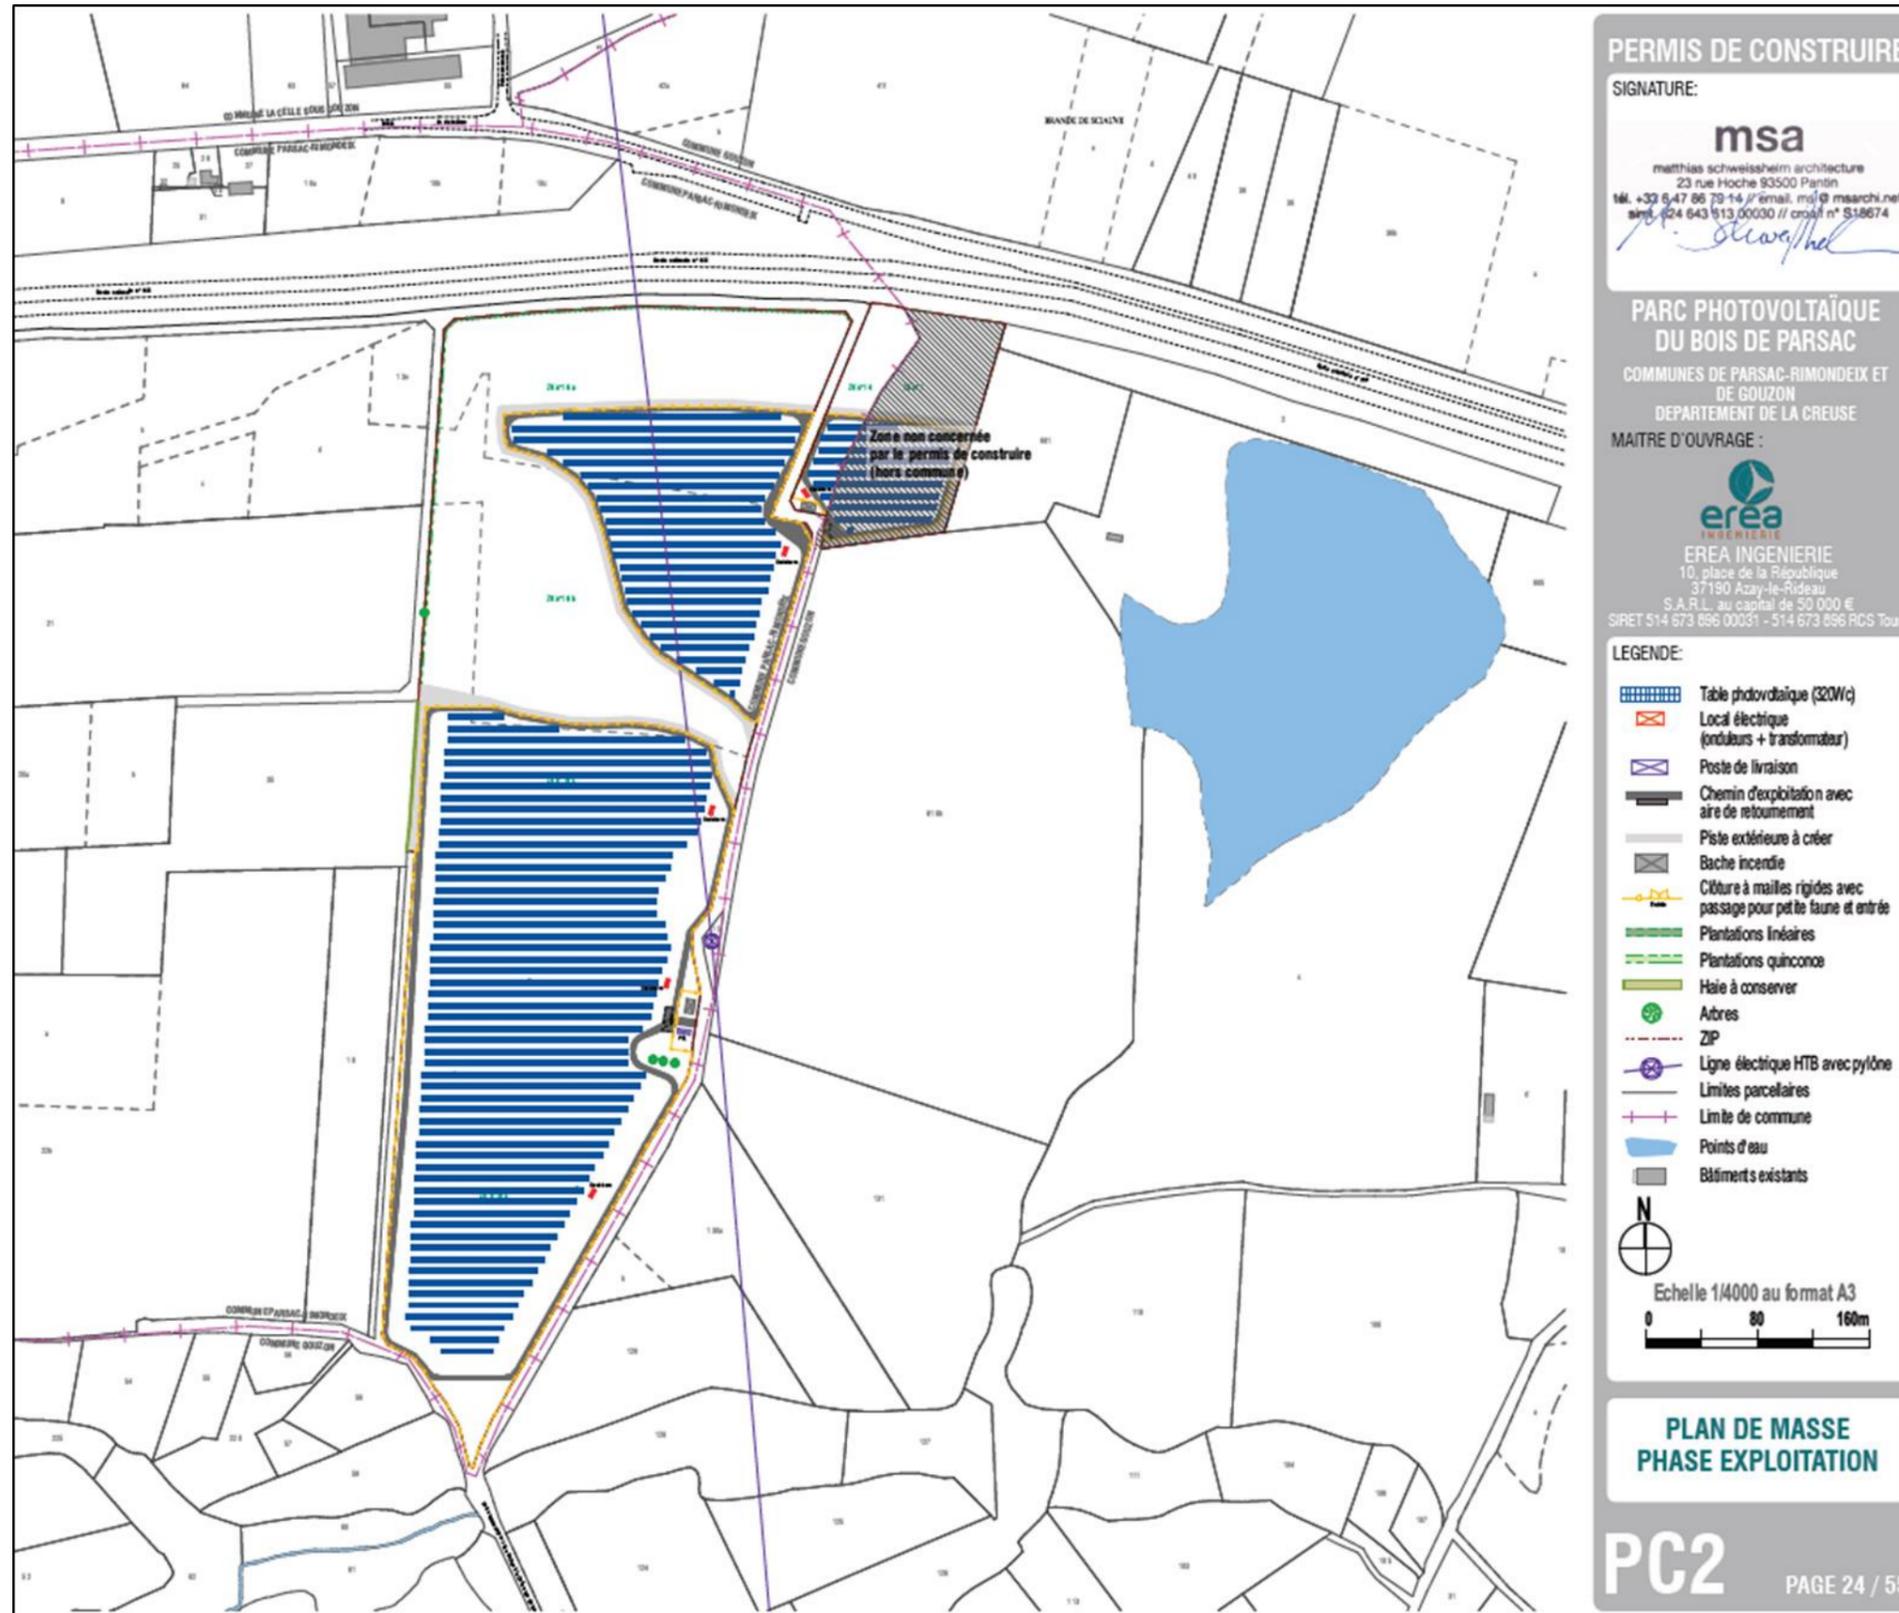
Plan de masse (Source : EREA INGENIERIE)
